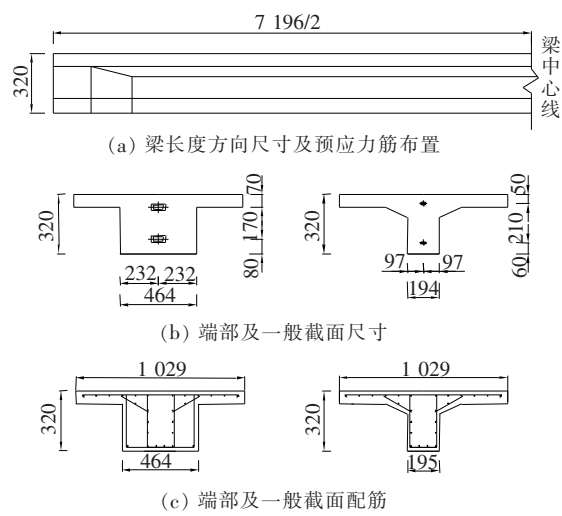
预应力混凝土模型梁尺寸及配筋(单位:mm)
